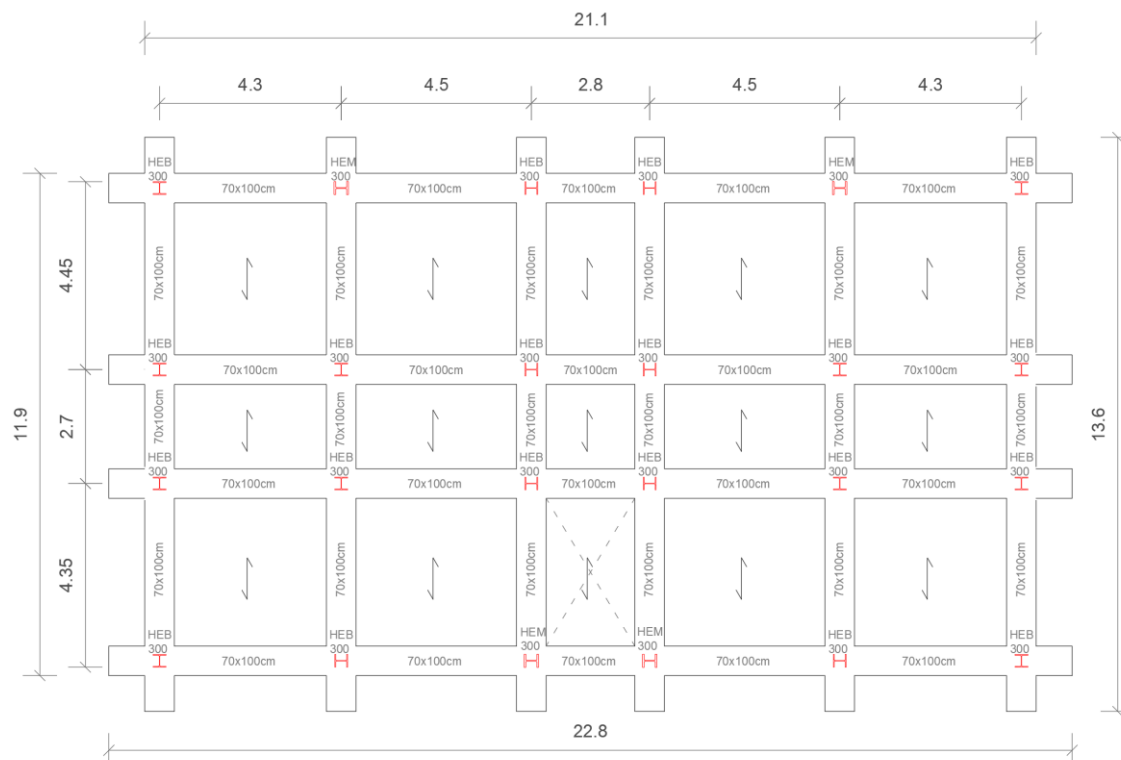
Carpenteria struttura in acciaio a due piani con graticcio di travi rovesce.
